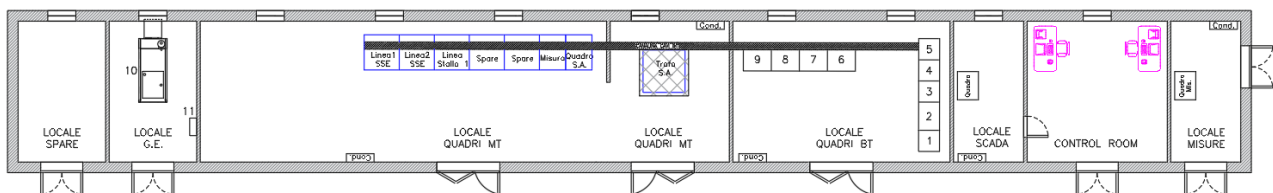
Stazione Elettrica Utente Stallo 1 – Planimetria
